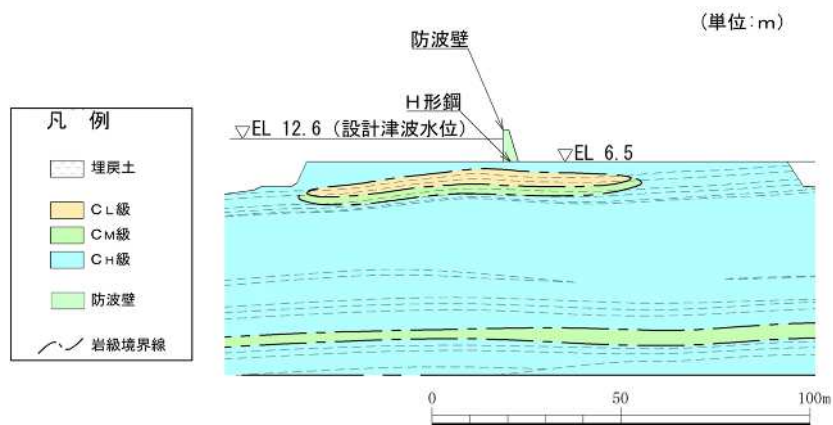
防波壁（波返重力擁壁）の横断面図
